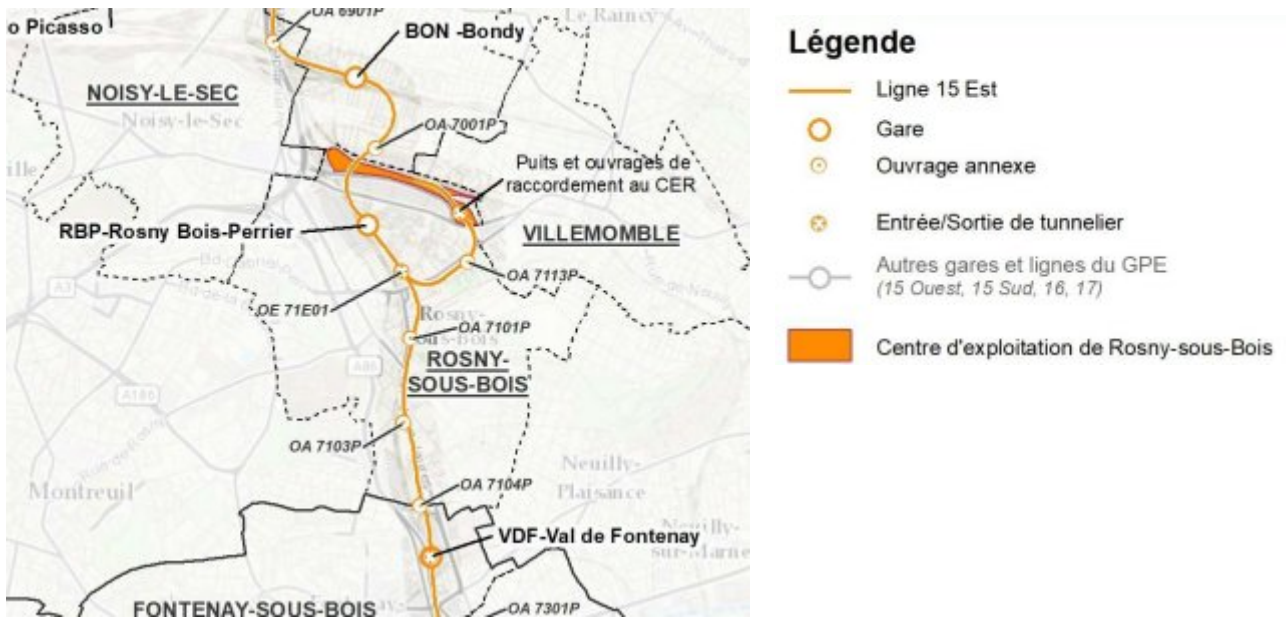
Extrait du plan de situation (source : pièce A1 p 26)
